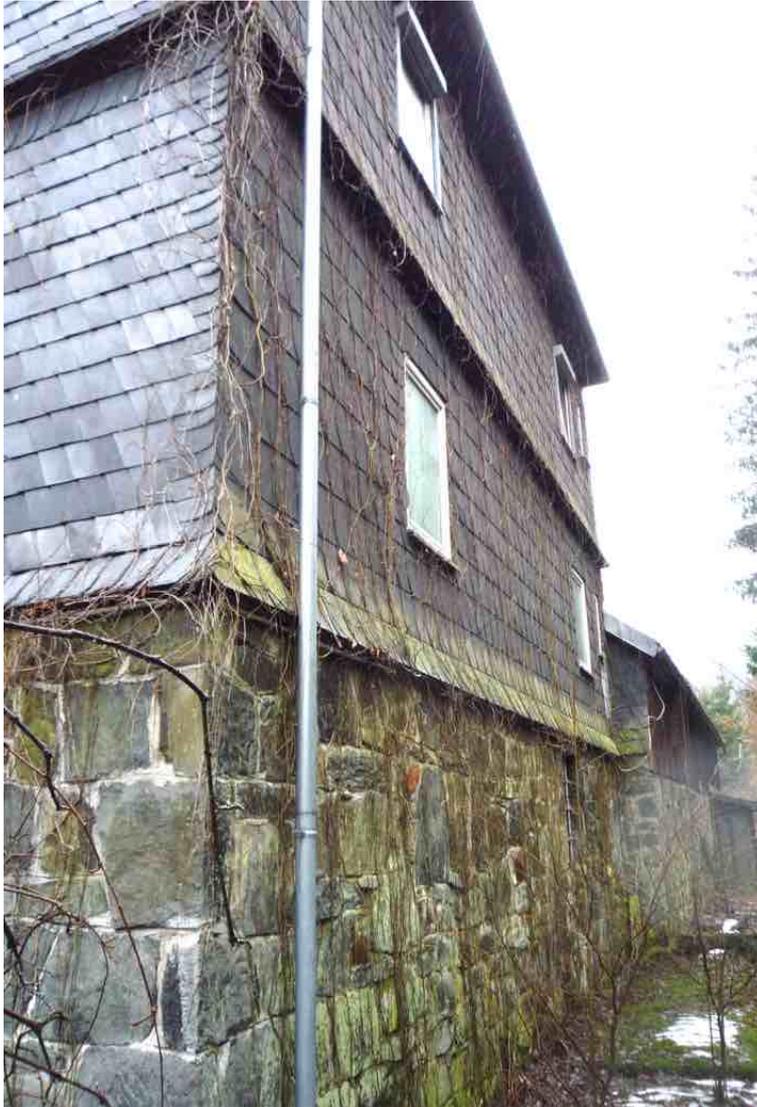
Blick auf die Nordwestfassade des Wohngebäudes.
